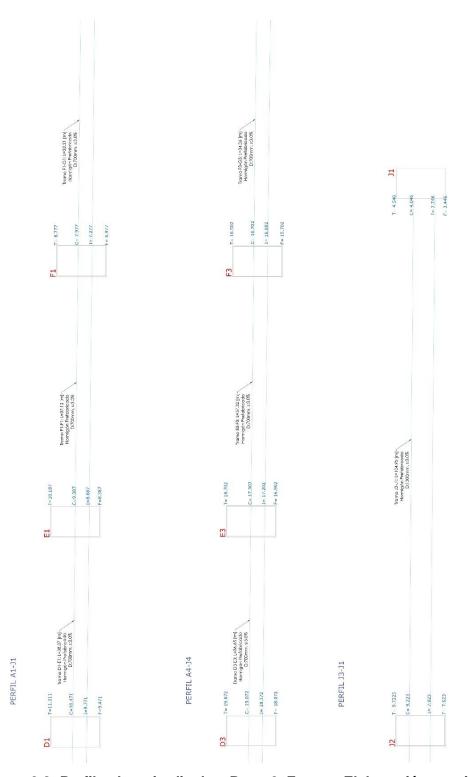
Perfiles Longitudinales. Parte 2. Fuente: Elaboración propia
